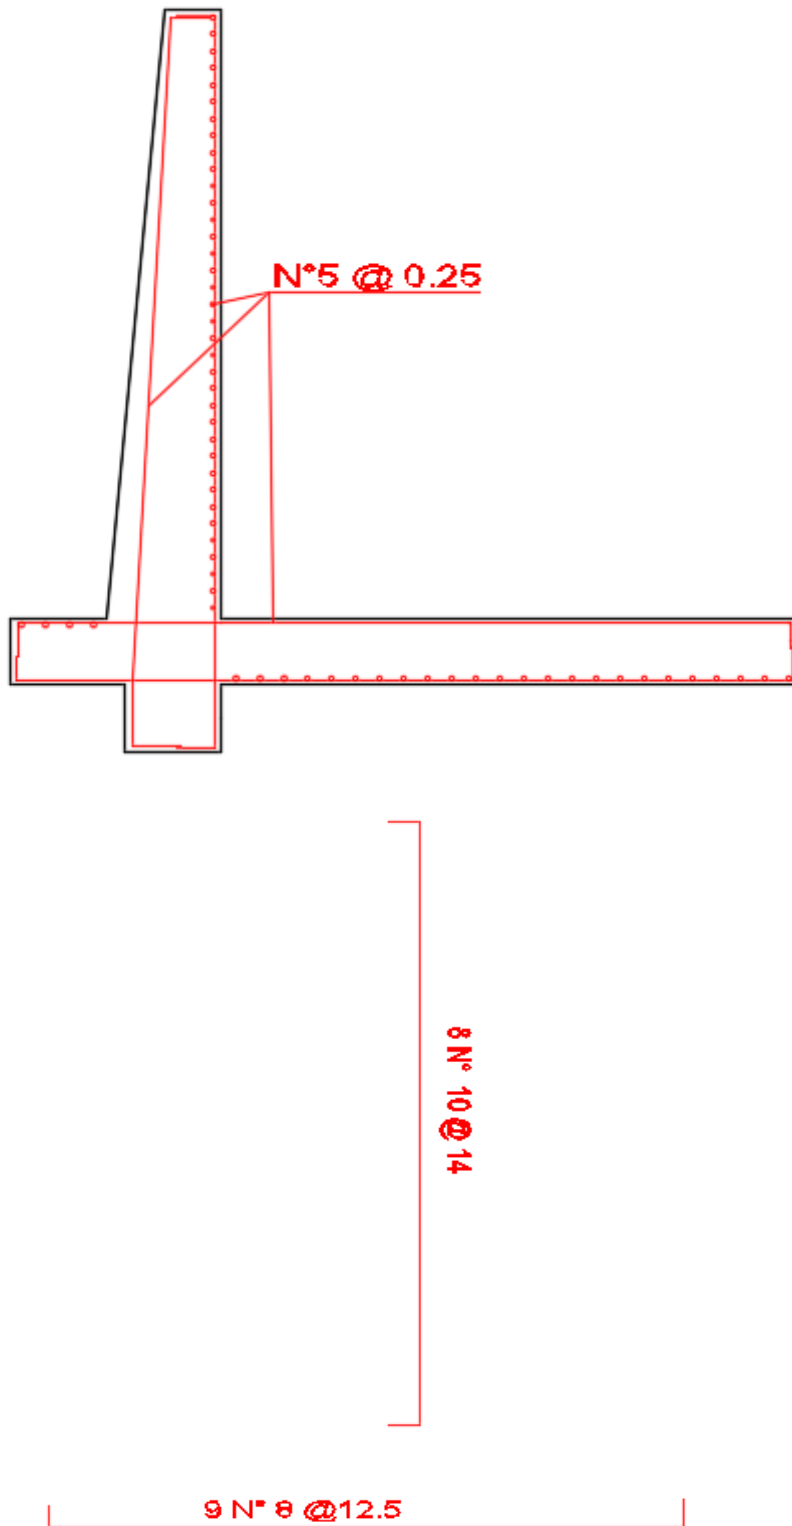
DESPIECE MURO CANTILEVER 15, 20, 35 CON ESFUERZOS DE PLAXIS
